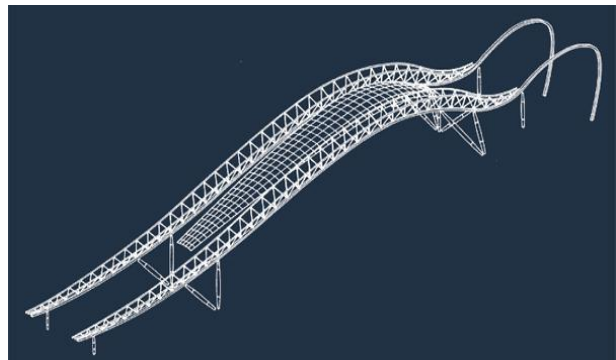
une toiture avec des poutres tridimensionnelles
